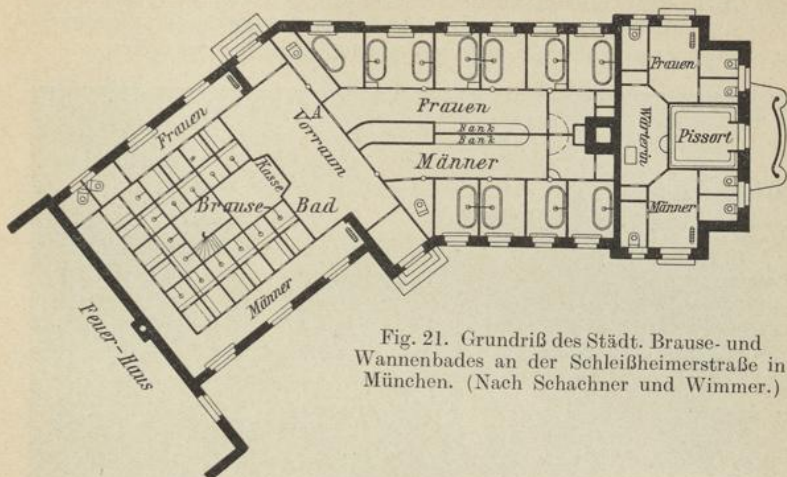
Grundriß des Städt. Brause- und Wannenbades an der Schleißheimerstraße in München. (Nach Schachner und Wimmer.)
